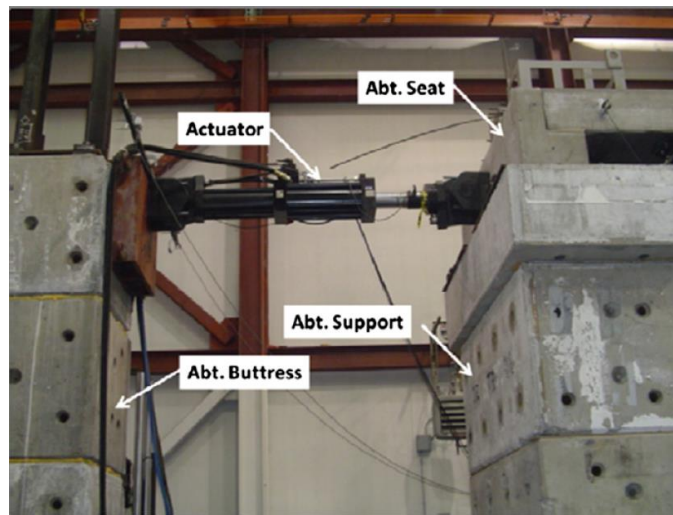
Detalle del Sistema de Estribo (Saiidi et al., 2013). Fuente: [21].
